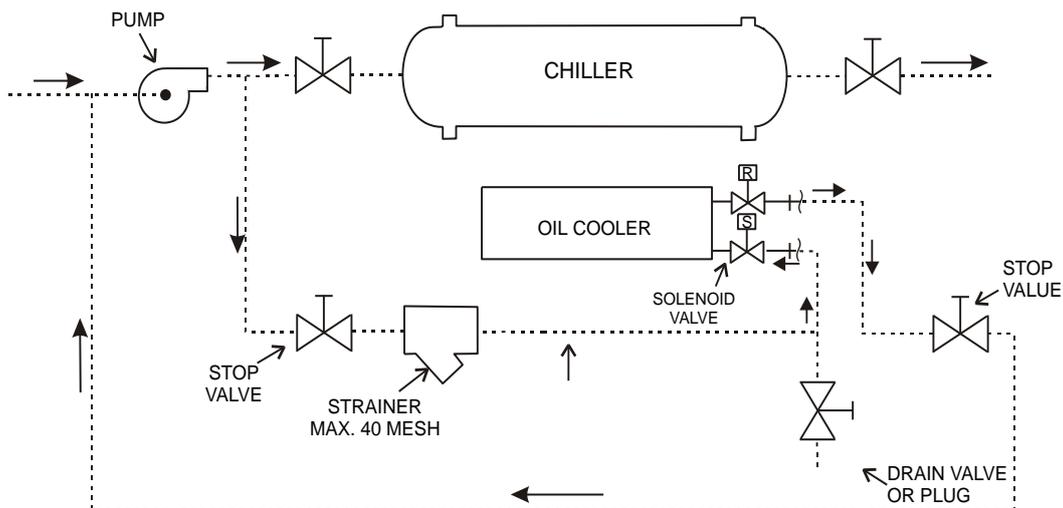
Схема трубопровода маслоохладителя с использованием городского водопровода
